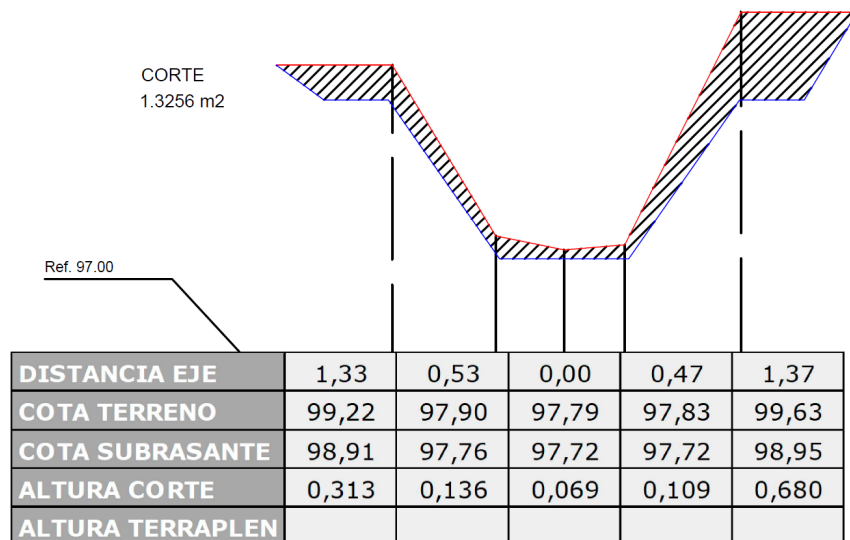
Perfil Transversal N°6 (Fuente Propia)
